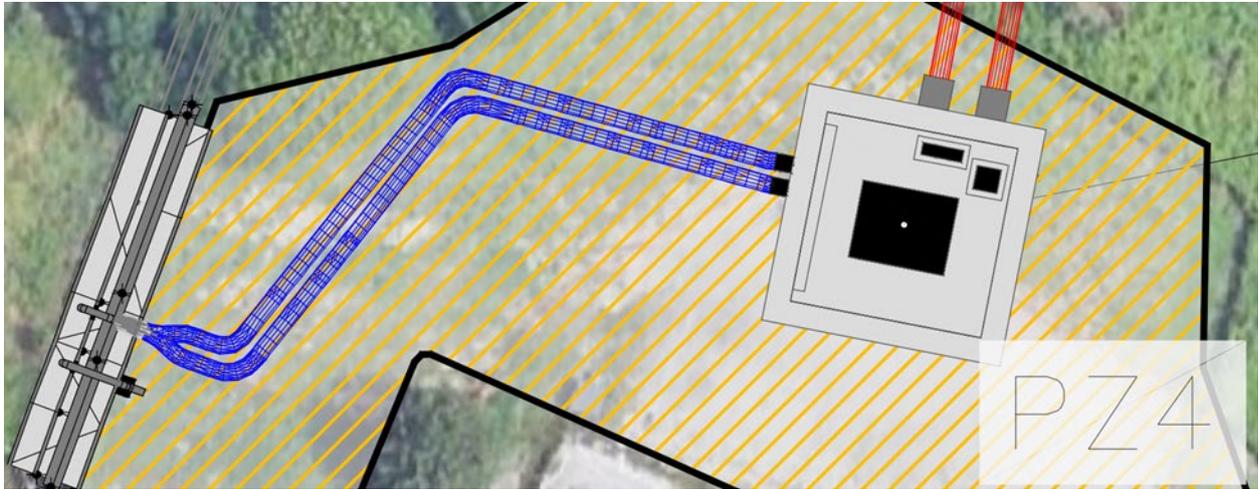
Tratto T5 di collegamento tra il pozzo PZ4 e la condotta esistente (in blu)
